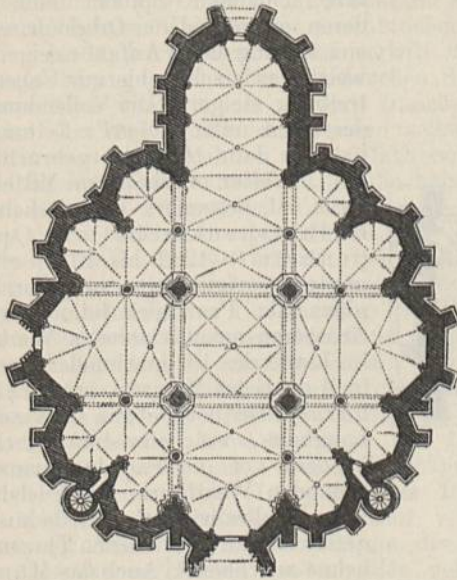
Grundriss der Liebfrauenkirche in Trier.
